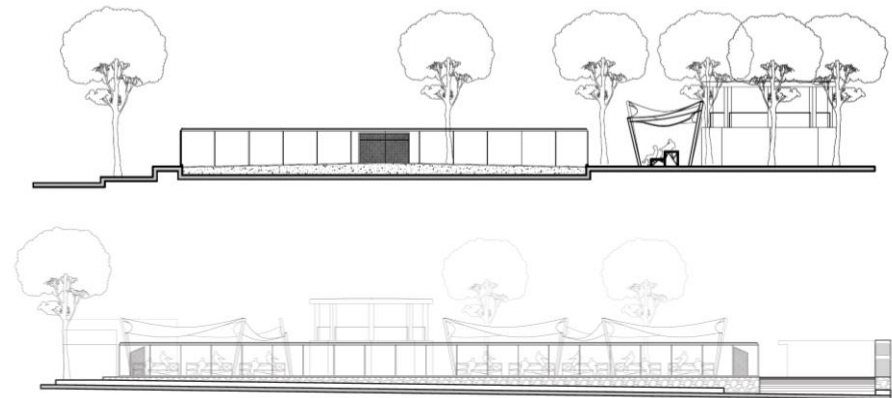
Planos de planta, sección y alzado de la primera propuesta. (Autoría 2017).
